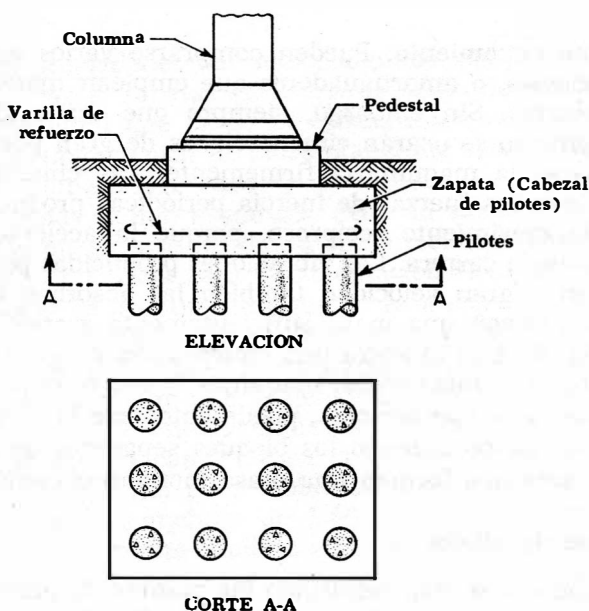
Pilotes soportando una columna de acero estructural.
